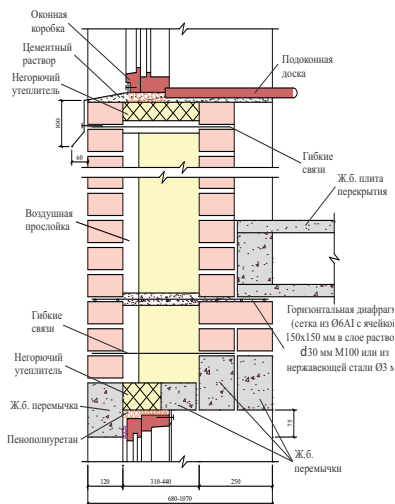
Надоконный и подоконный узлы наружной стены из кирпичной кладки толщиной 68-107 см с вертикальными кирпичными диафрагмами (с подоконной нишей)
